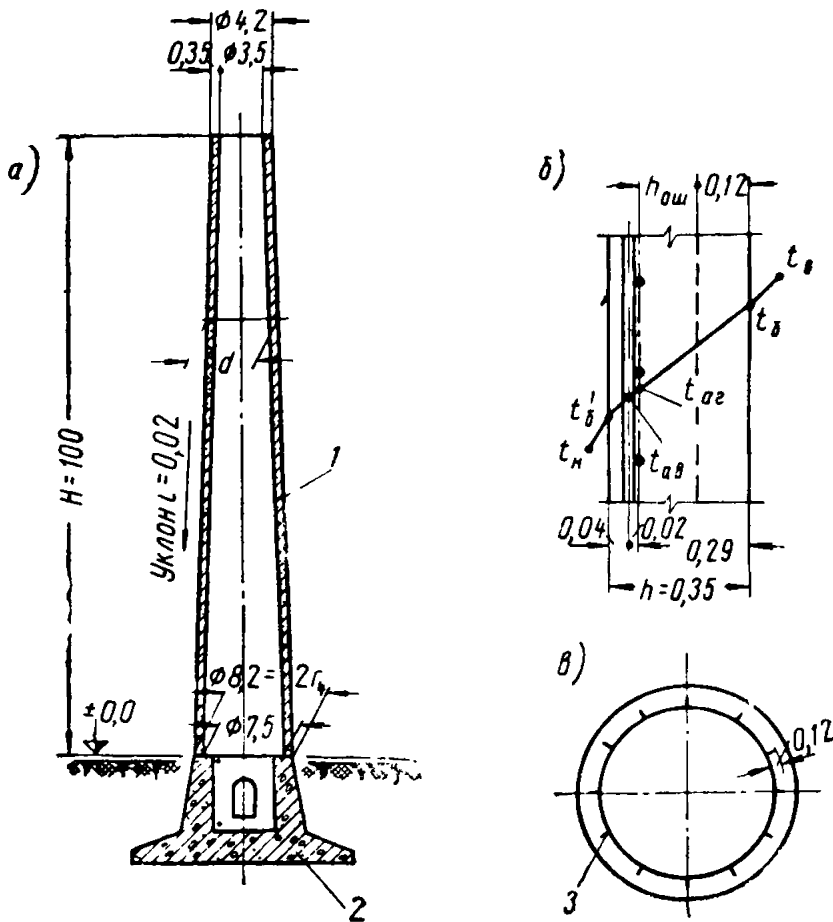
Дымовая труба из жаростойкого железобетона (к примеру расчета № 2)
